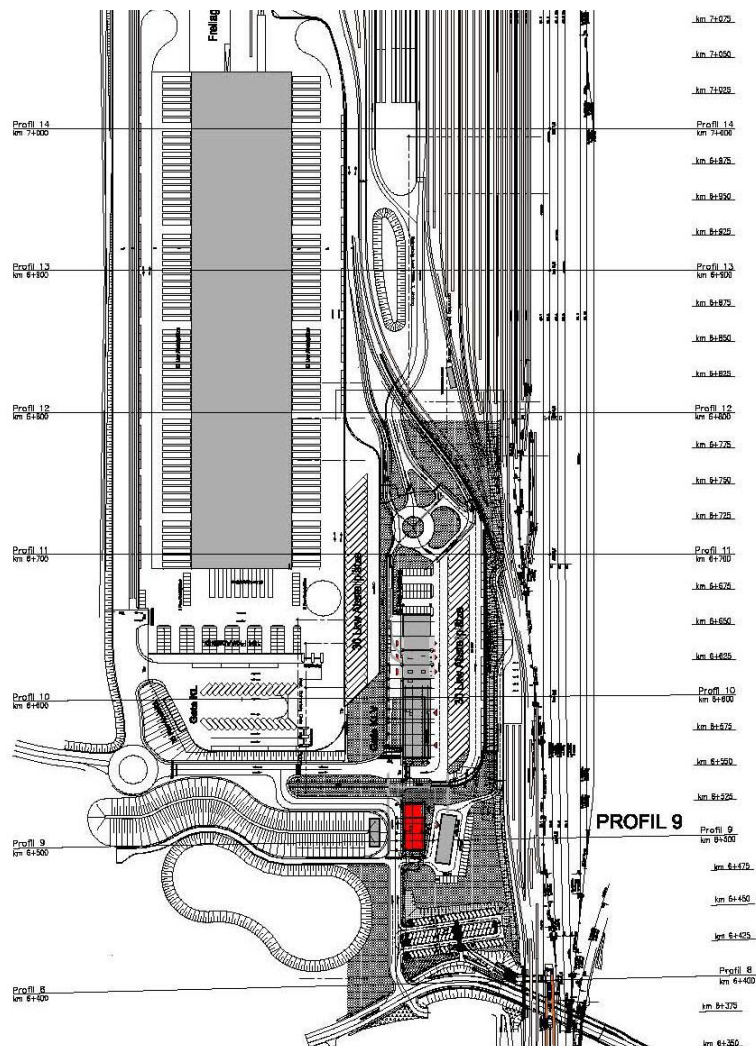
Lagegrafik Betriebsgebäude Nord (rot)
